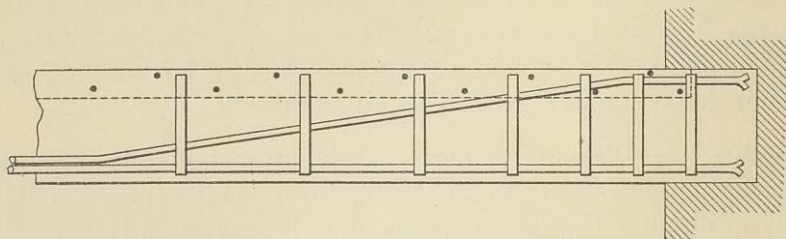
Extrémité de l'armature d'une poutre, système Hennebique.
